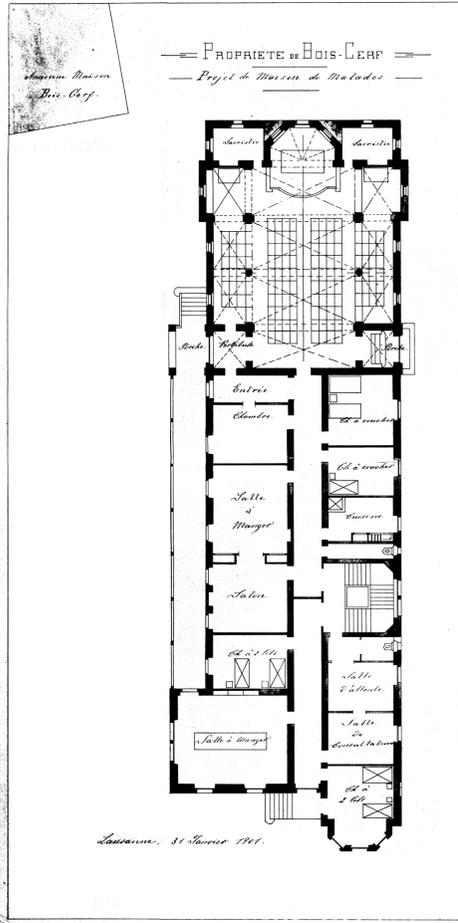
Lausanne, Clinique Bois-Cerf, premier projet de plan pour le rez-de-chaussée, 1901 (AVL).
